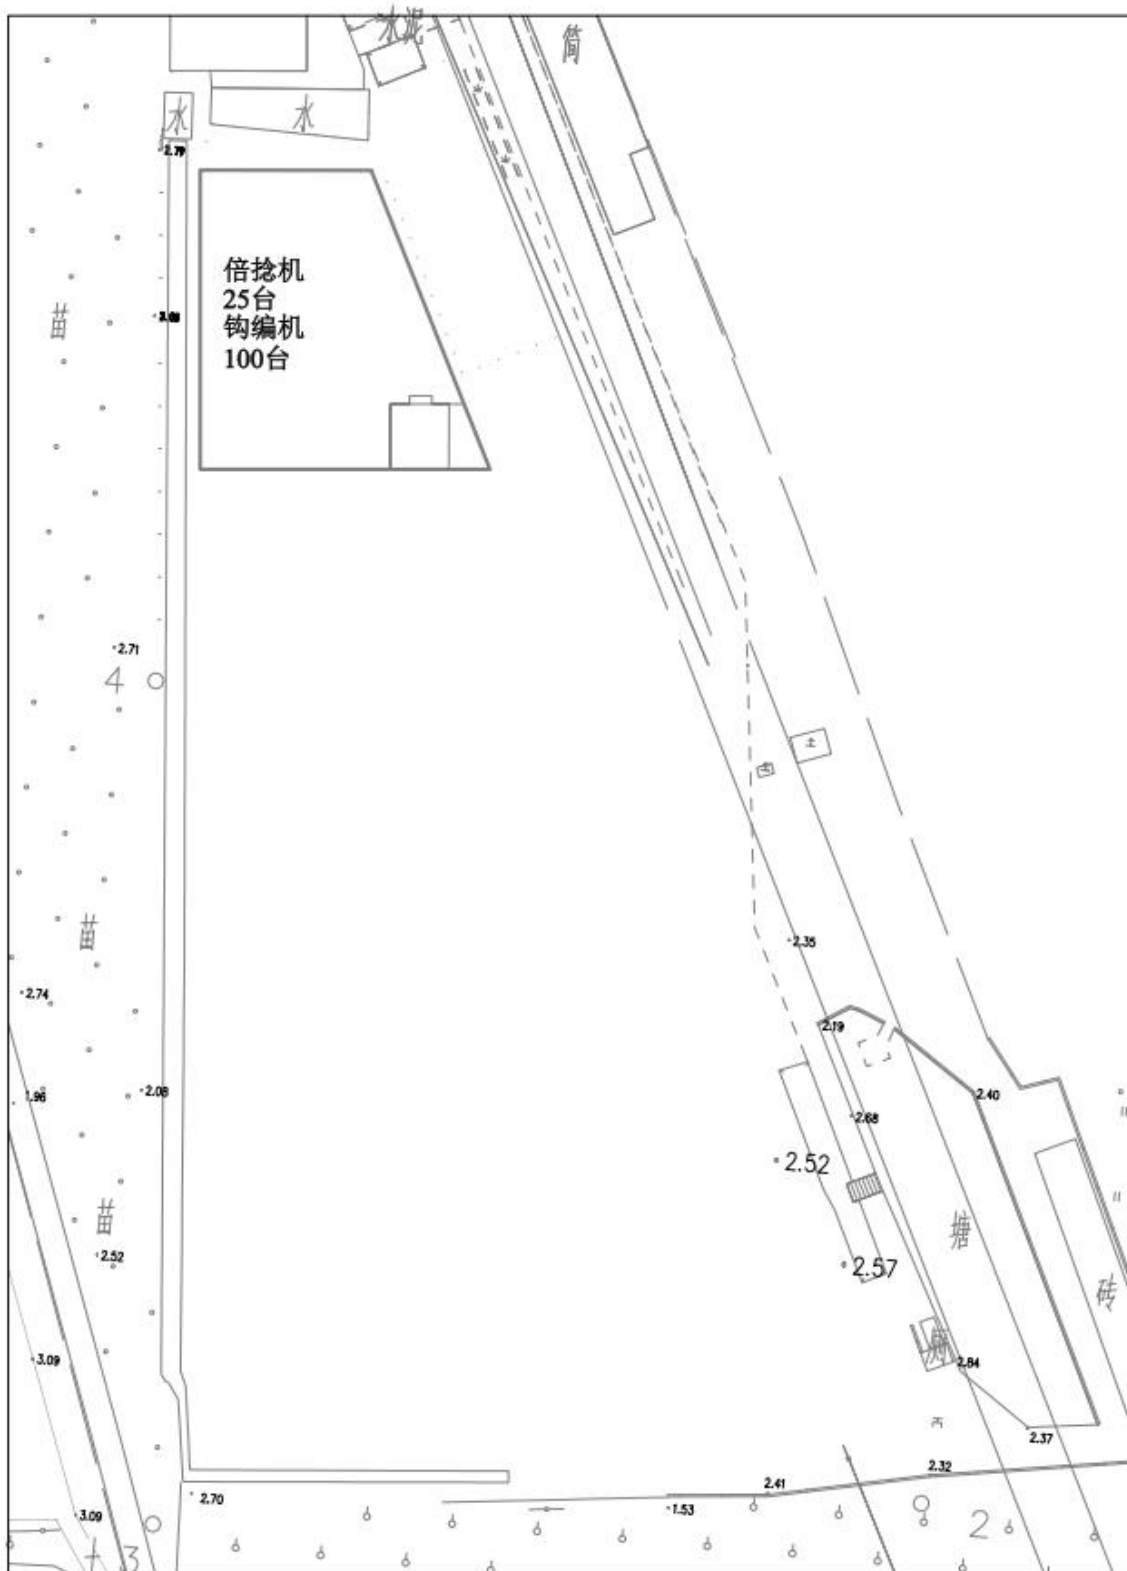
项目五层平面布置图（比例尺 1: 600）
